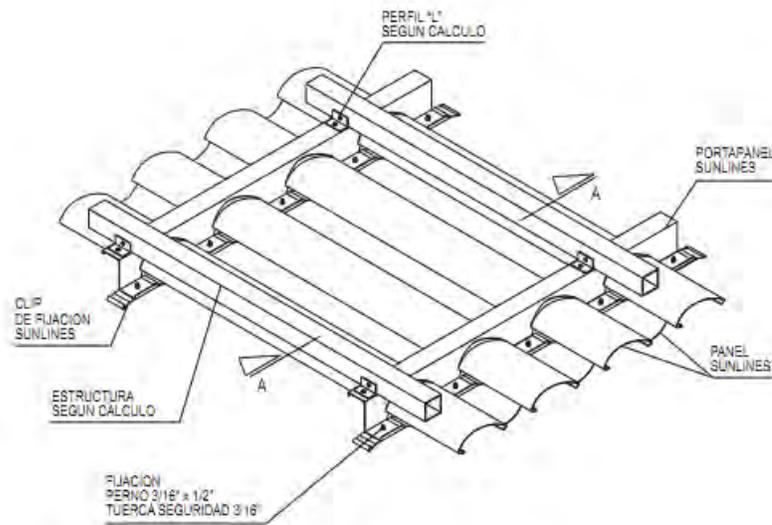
Detalles de instalación y montaje del cortasol Sunlines.
